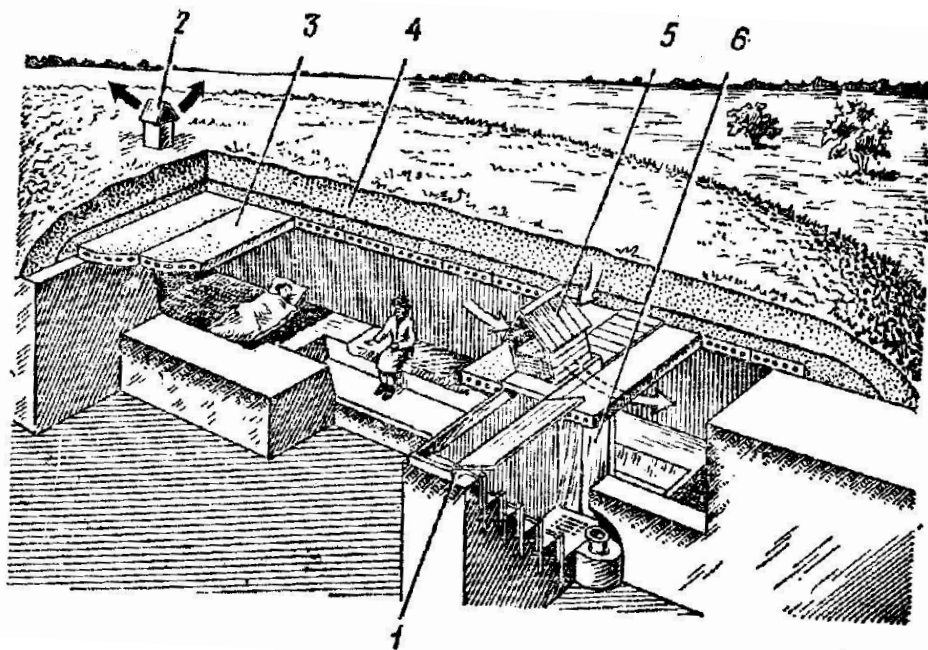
Противорадиационное укрытие с перекрытием из железобетонных плит
